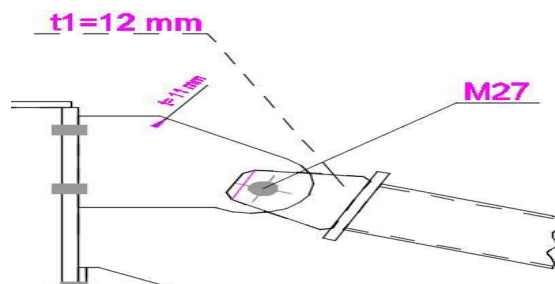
8 : Vue en plan de l'assemblage de la chape avec tirant
